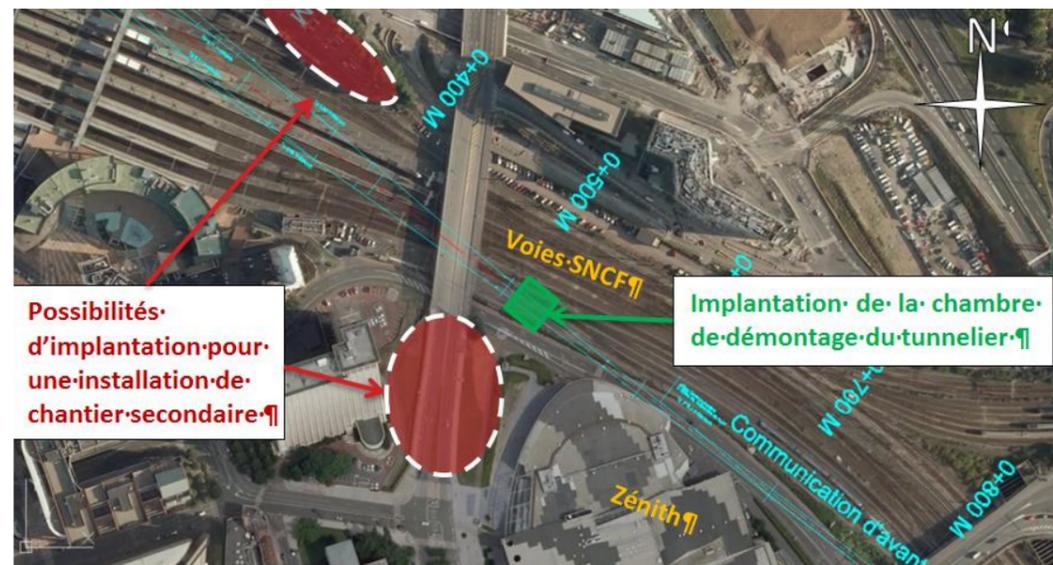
Implantation possible pour la base d'installation de chantier secondaire
